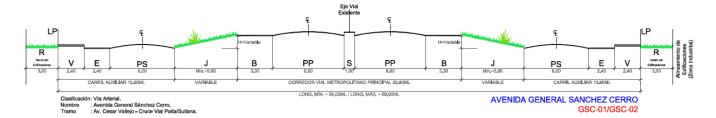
Sección Vial de la Av. Sánchez Cerro
